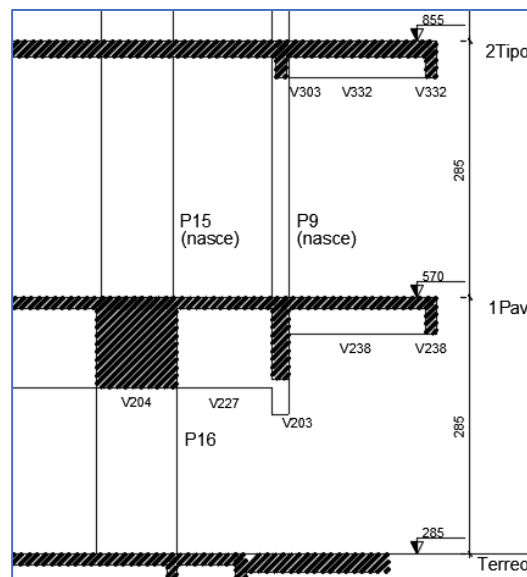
Detalhes do corte – vista dos pilares em transição – Pilares em transição. Fonte: Autores
